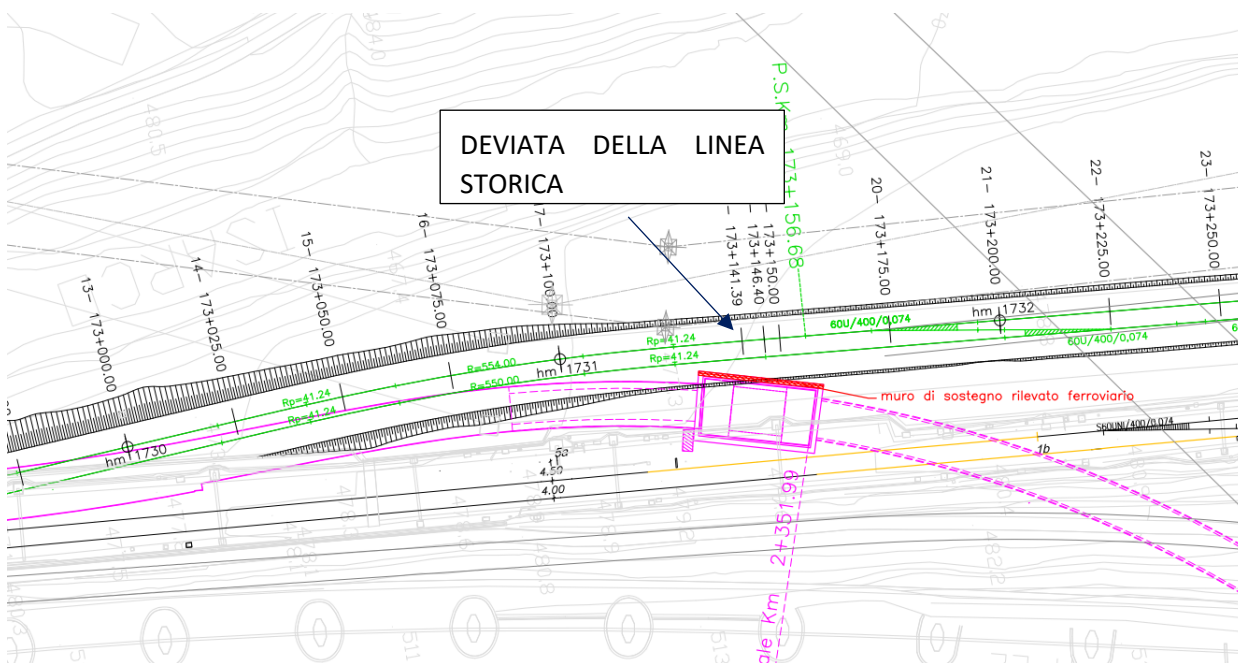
Sottoattraversamento linea storica: Progetto definitivo
